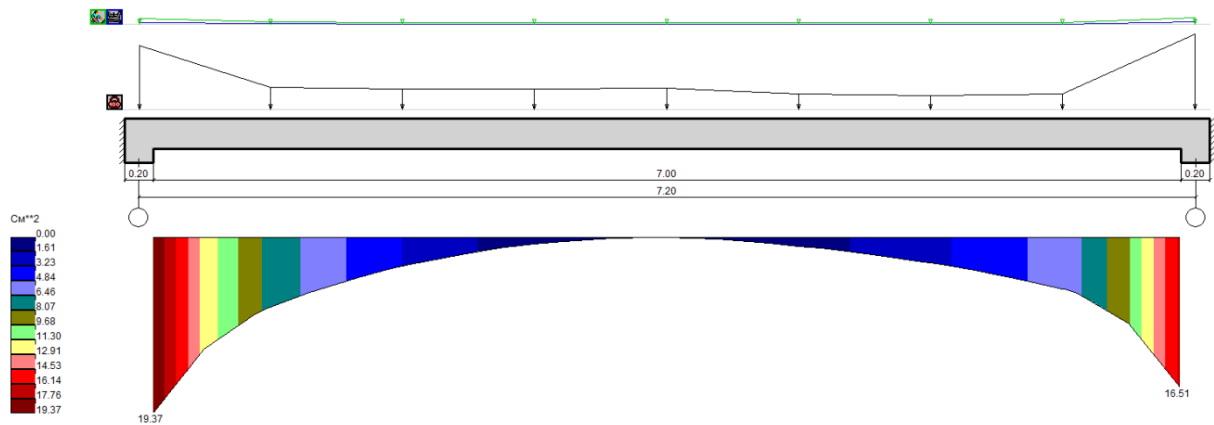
Поперечне армування балки перекриття типового поверху
